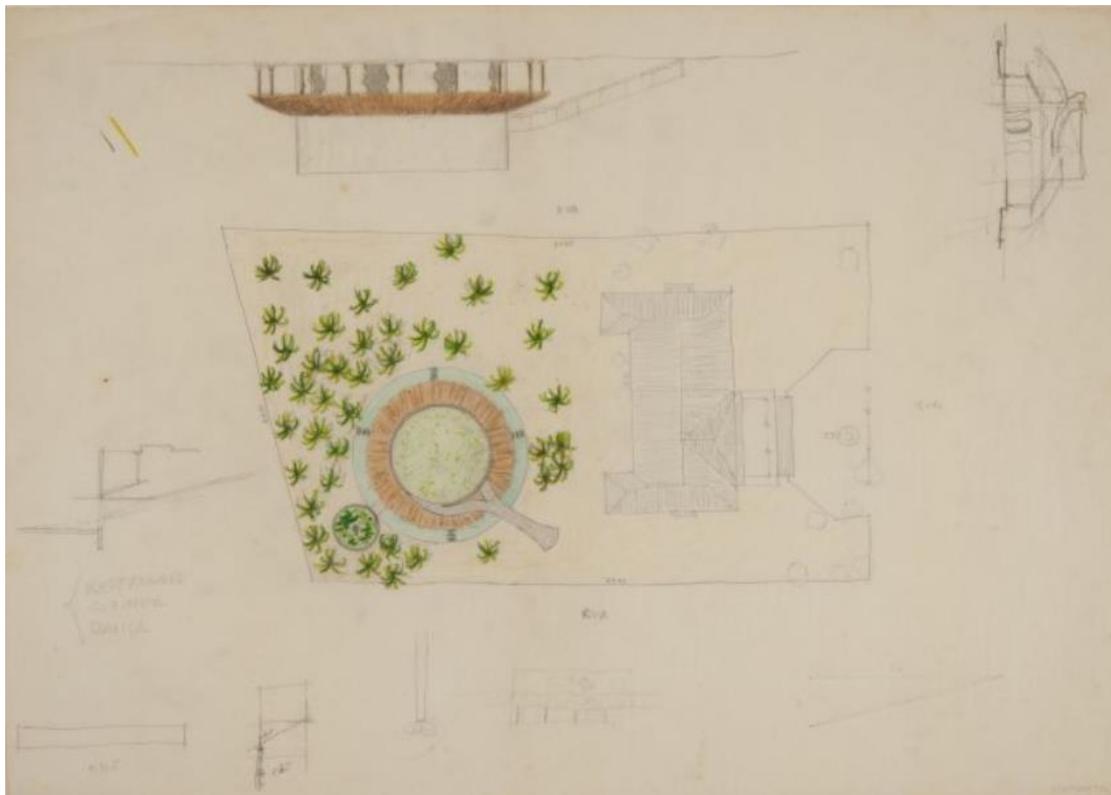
planta del restaurante africano de la Casa do Benin, Lina Bo Bardi, 1989, archivo Instituto Bardi
